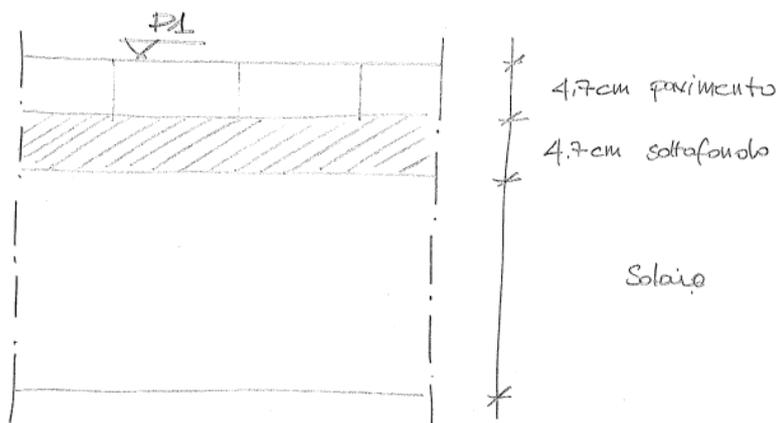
SONDAGGIO 10C – Nella stanza è stato fatto un sondaggio sul pavimento da cui si sono rilevate le presenti stratigrafie.
